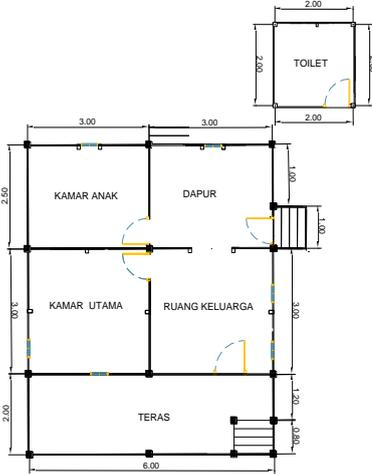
Denah Lantai 2 Rumah Bantuan Pasca Tsunami Bapak Sarial M. Tayed (Analisis penulis, 2025)
